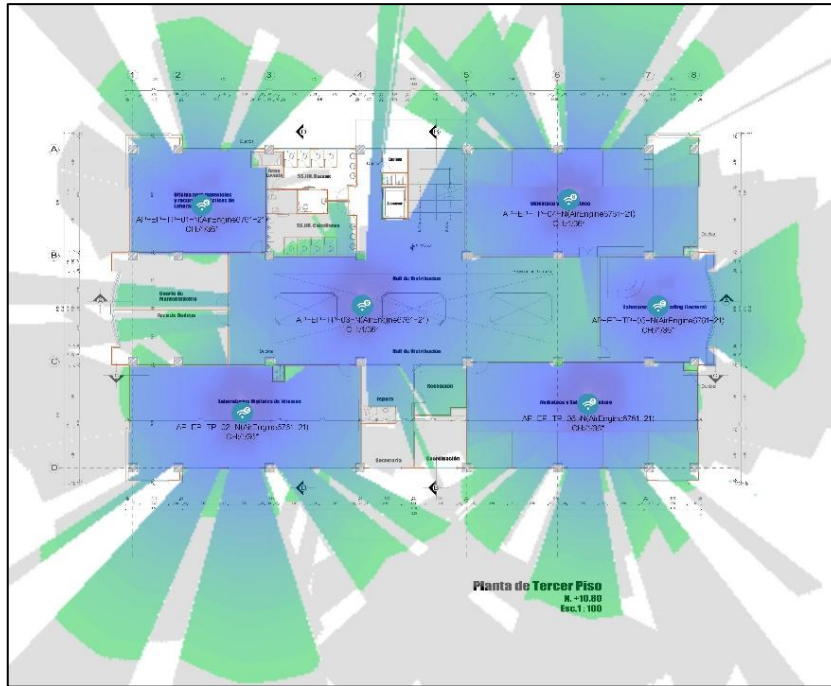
Edificio de Posgrados - Planta de Tercer Piso
